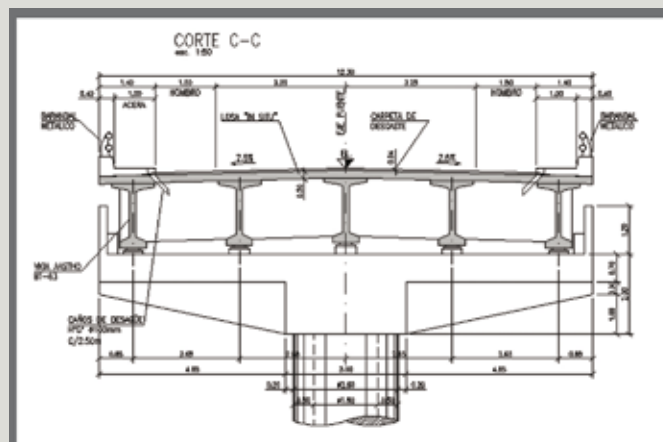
Sección transversal tablero Sta. Rosa de Guachipilín
